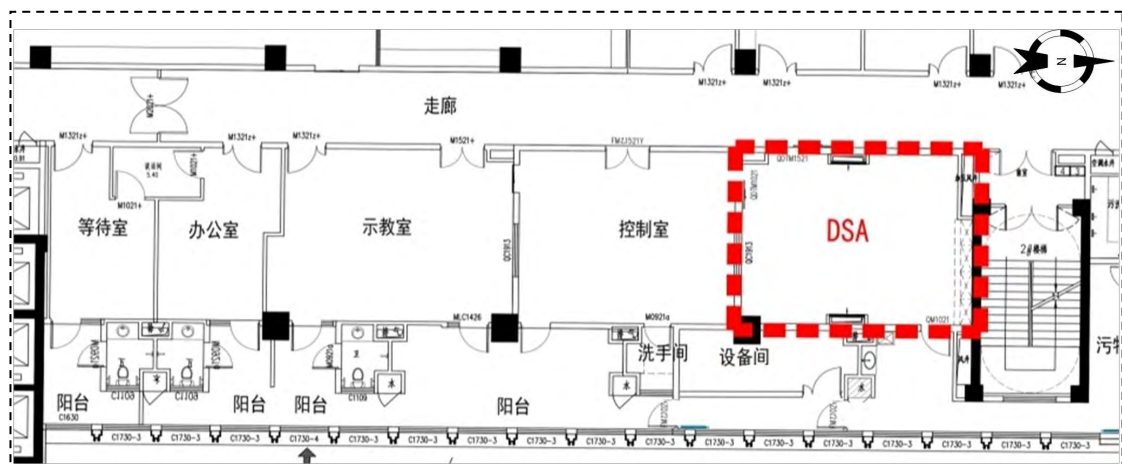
DSA 机房所在楼层平面布置图（老年医学中心楼十六楼）
